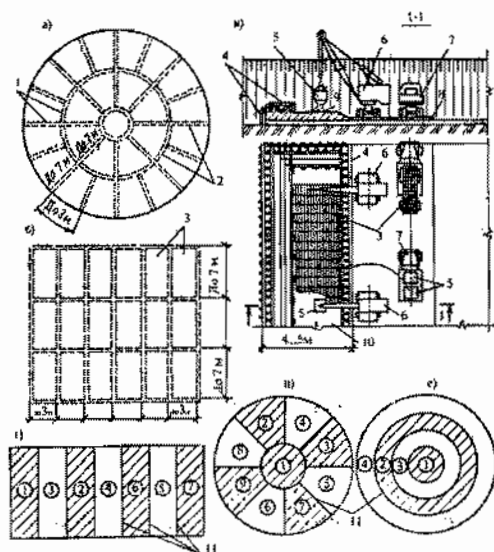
Схемы организации работ при устройстве днища емкостных сооружений: 1 - контуры каркасов; 2 - нахлестка арматурных каркасов; 3 - сетки в виде рулонов; 4 - опалубка; 5 - бады; 6 - кран; 7 - автомобили, доставляющие арматурные каркасы и бады с бетоном; 8 - временный настил для проезда кранов и транспорта; 9 - укладка бетона; 10 - забетонированное днище; 11 - рабочие швы, места установки опалубочных досок (цифры в кружках указывают последовательность бетонирования)
